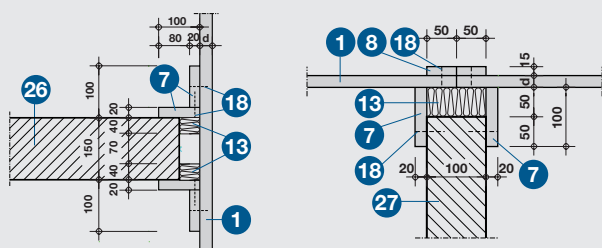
Detail D – průstup stěnou - čtyř nebo třístranné provedení kanálu
